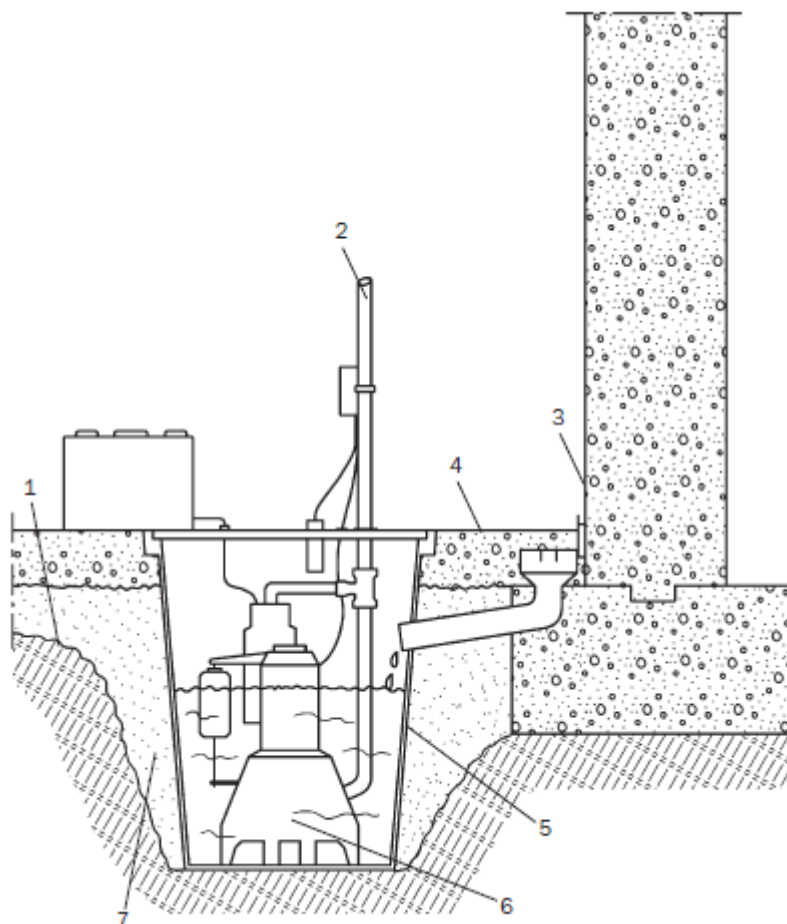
Схема внутреннего отведения воды: 1 – слой пароизоляции; 2 – отводная труба; 3 – пластиковый профиль; 4 – бетонная плита; 5 – водосборник; 6 – насос; 7 – слой гравия
